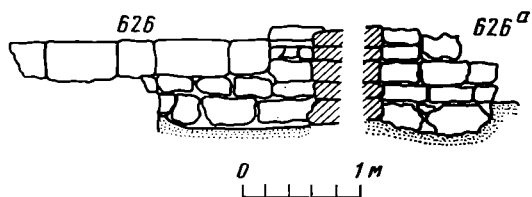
а. Фасировки кладок стен № 626 и 626а — южной и западной стен здания Думберга (фасировка выполнена в 1965 г.).
